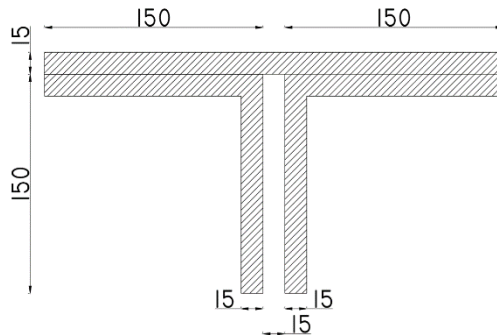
Sambungan Baut pada Sisi Box Girder
